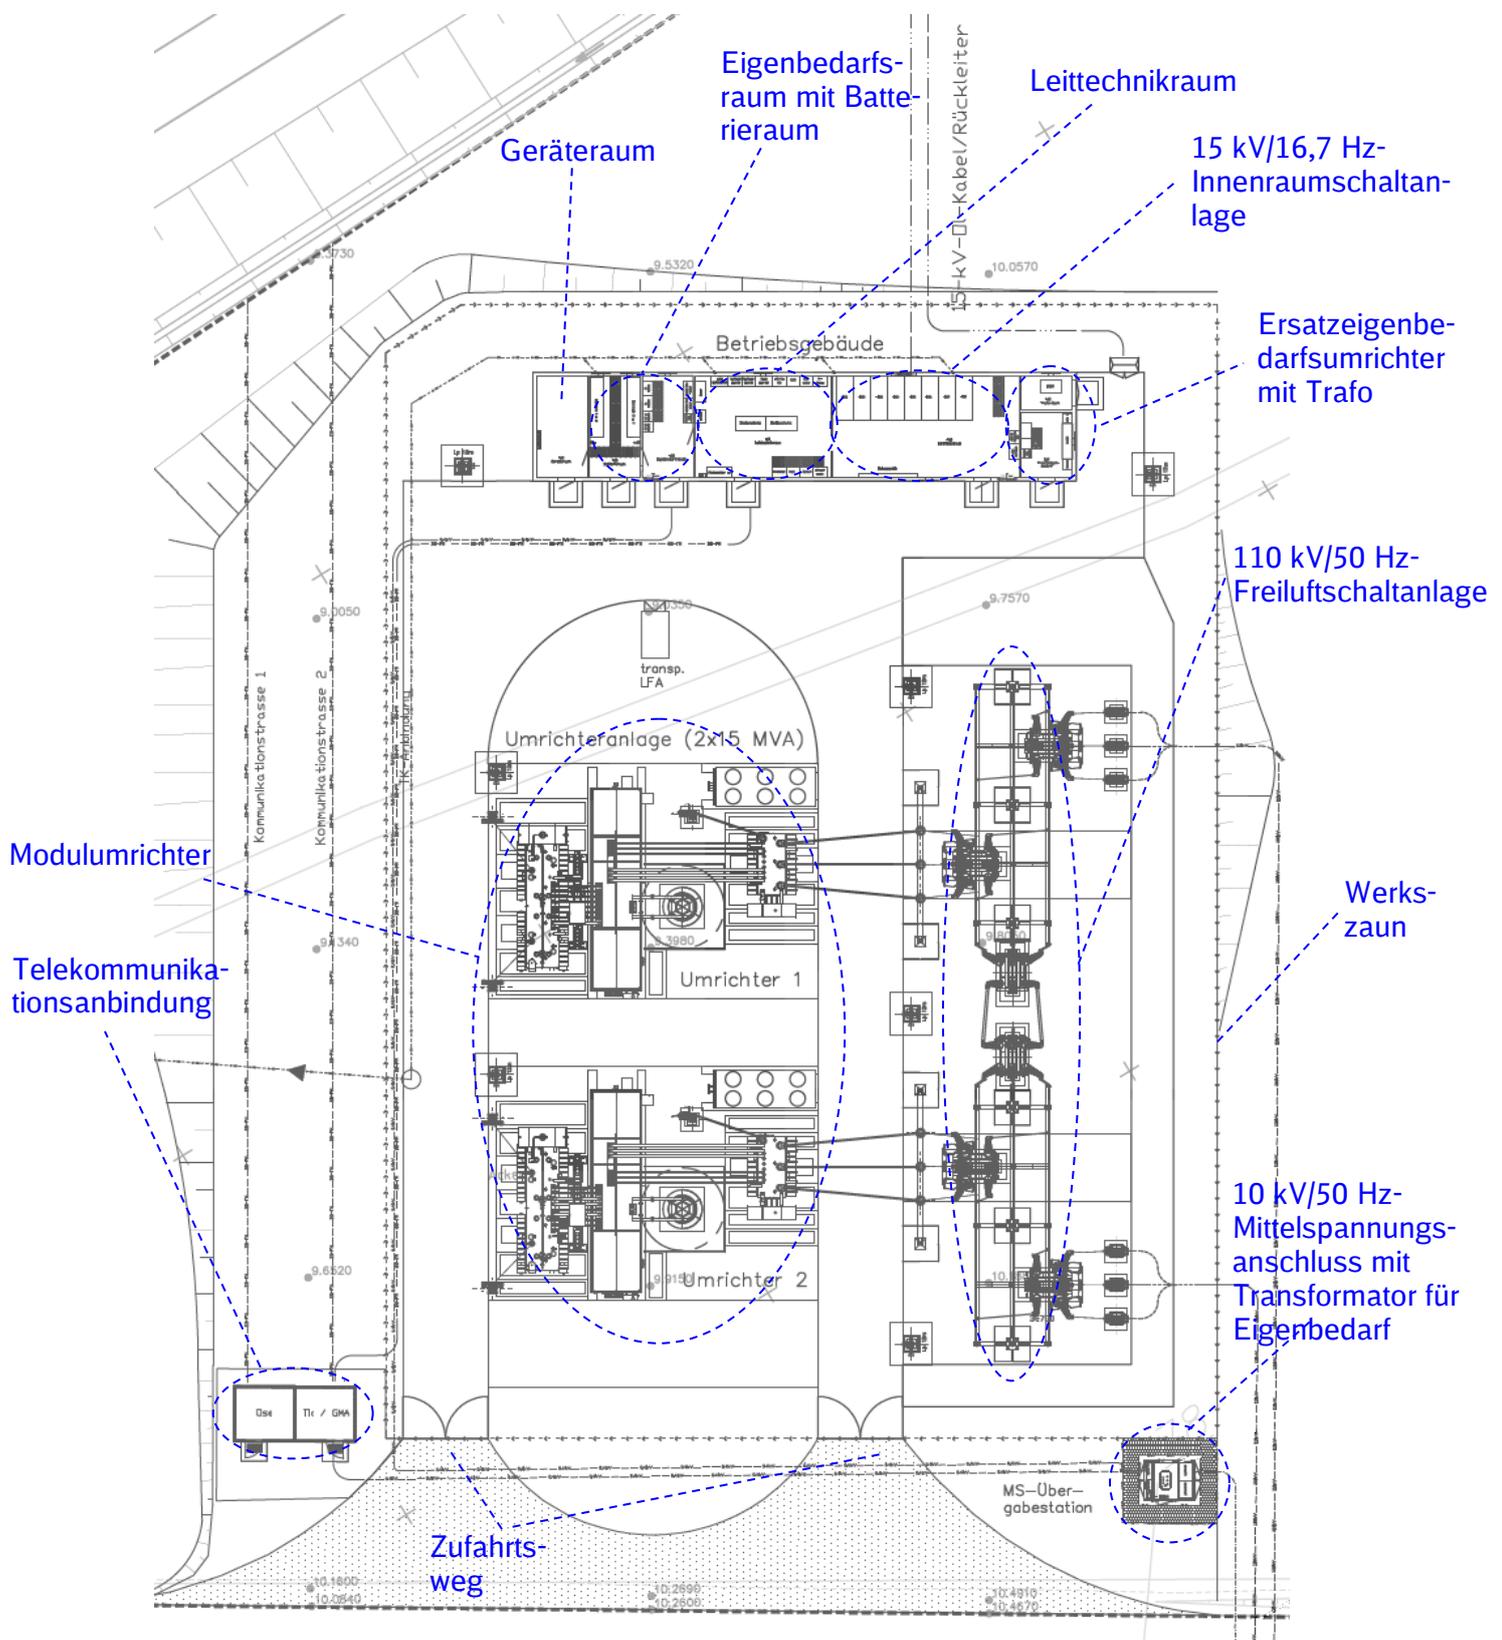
Grundriss des geplanten Umrichterwerks Göhl
